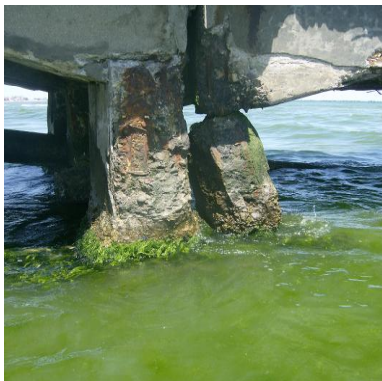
Elemente din beton supuse acțiunii vegetației (foto autor)
